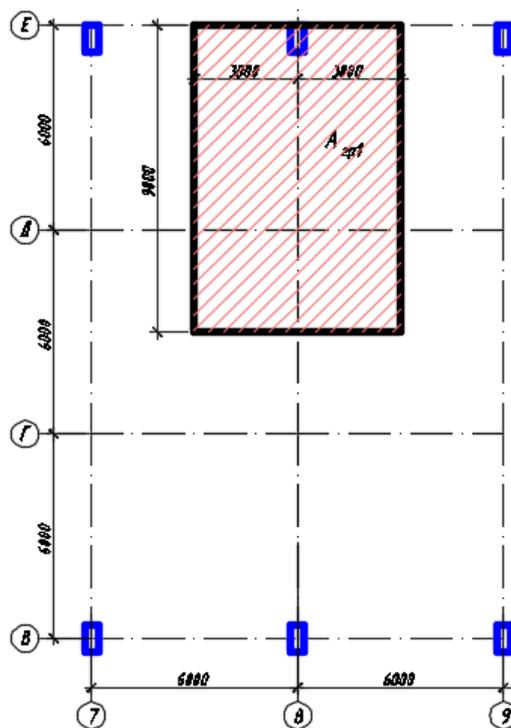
Грузовая площадь на фундамент в осях 8/Е
